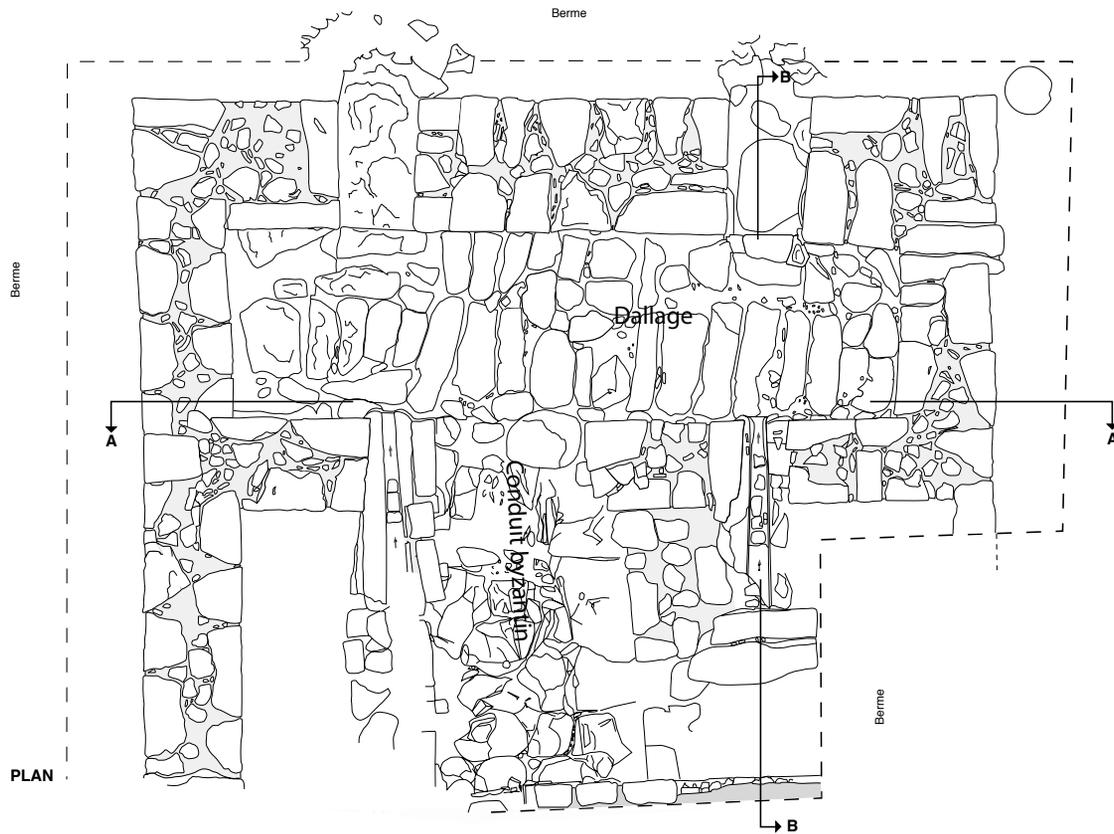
Plan et coupe du moulin hydraulique omeyyade (relevés : Laurent Baqué, Pierre Dubœuf et Pierre-Marie Blanc ; compléments et DAO : Pierre Dubœuf).
